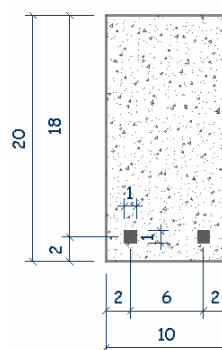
Seção equivalente de concreto armado, cotas: cm.
